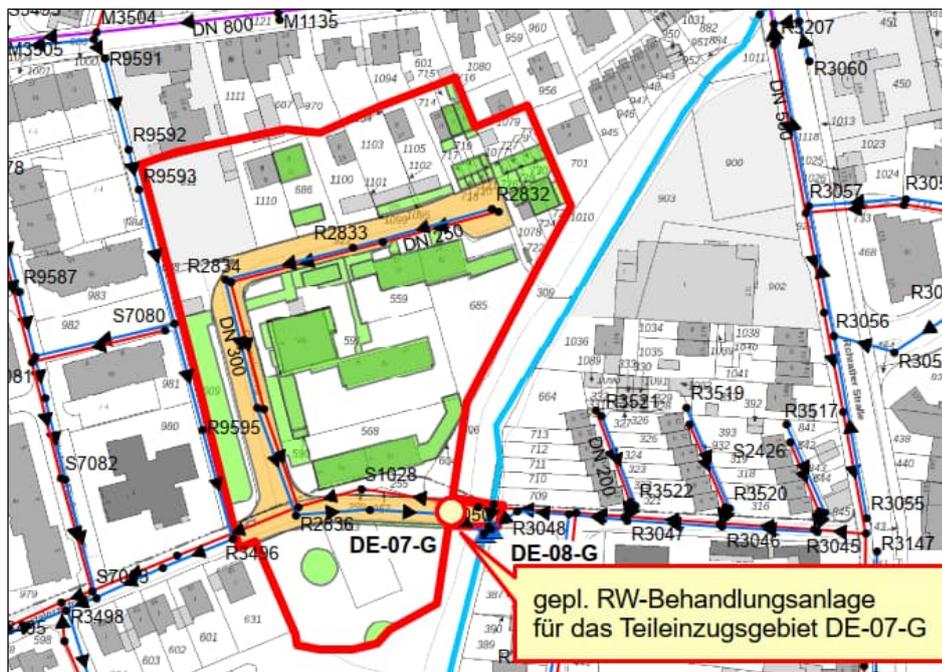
Geplante Lage RW-Behandlungsanlage DE-07-G
